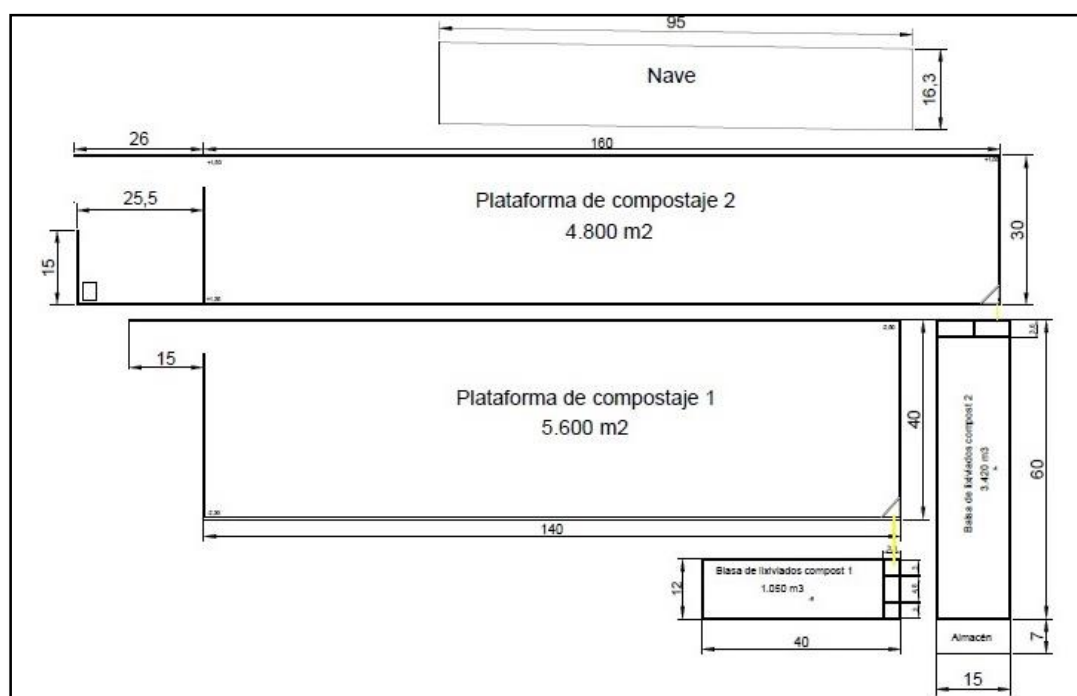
Plano en planta de las instalaciones de la planta de compost de Coto Bajo.
